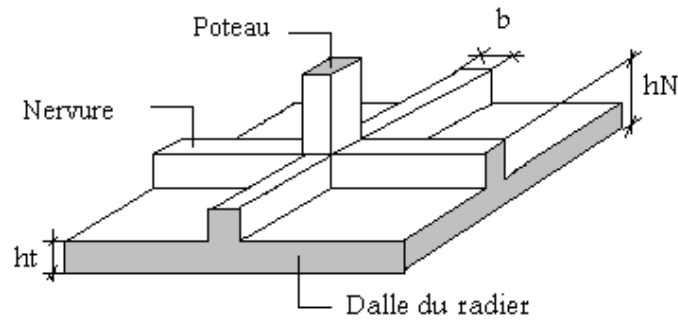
Disposition des nervures par rapport au radier et aux poteaux
